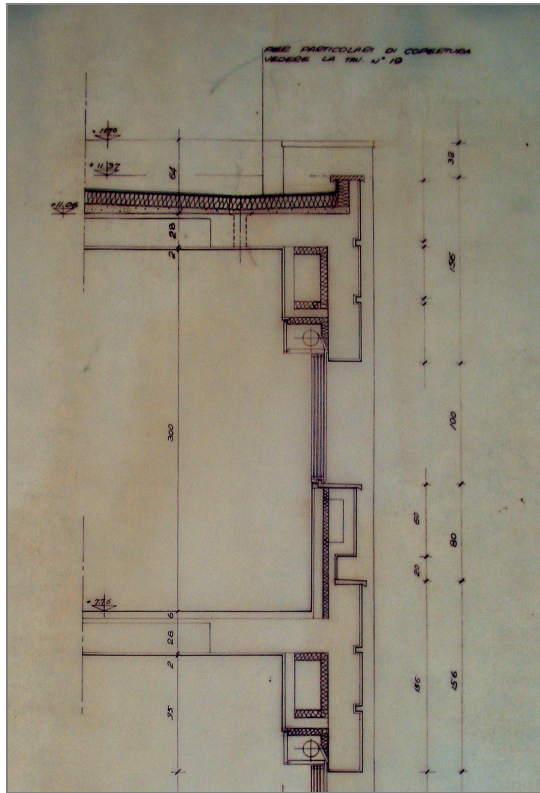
sezione corpo A – piano terzo (fonte CSAC – stralcio tav. 37, archivio n. 400-1)
